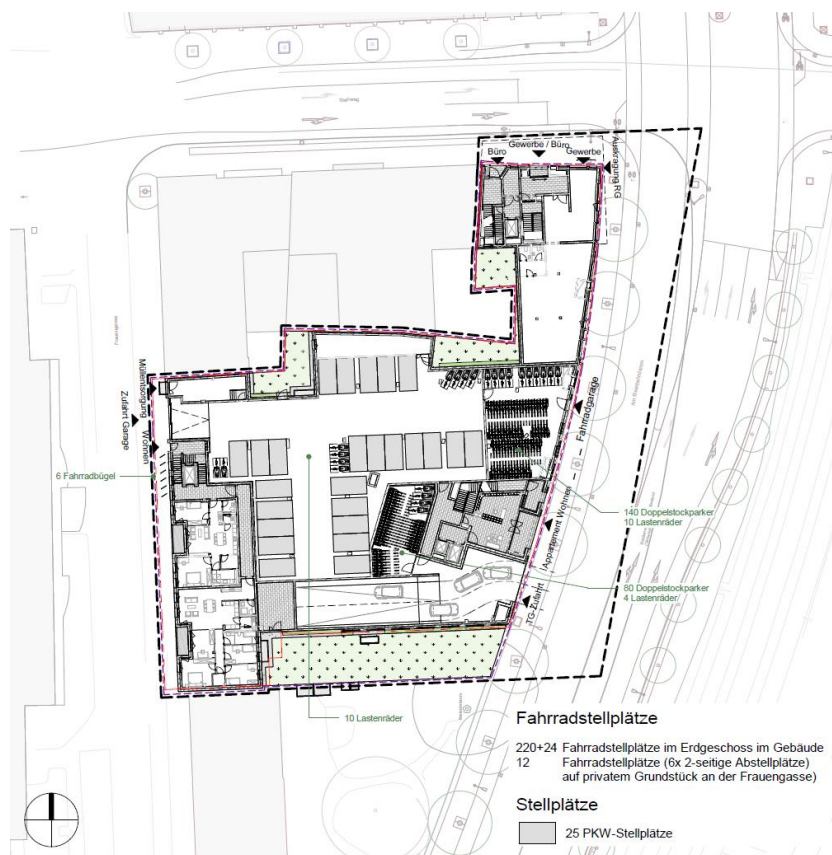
Grundriss Erdgeschoss (Grafik: AS+P)
